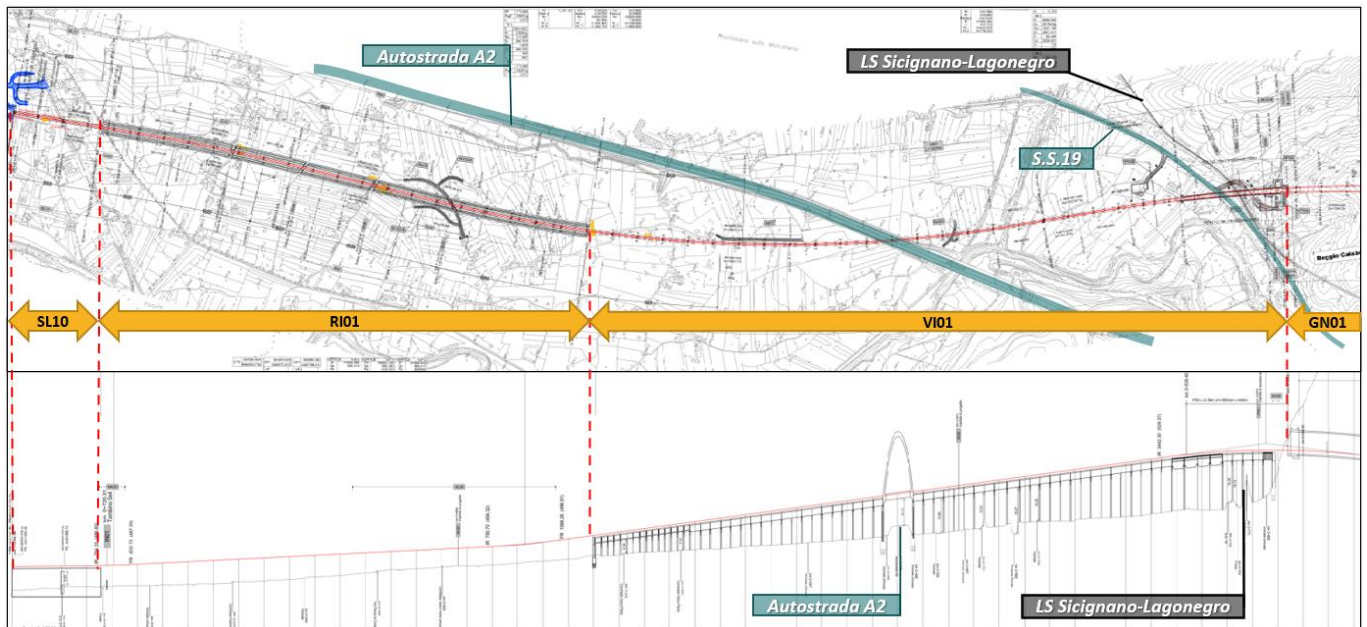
Planoprofilo di progetto da km -1+094 al km 3+940
